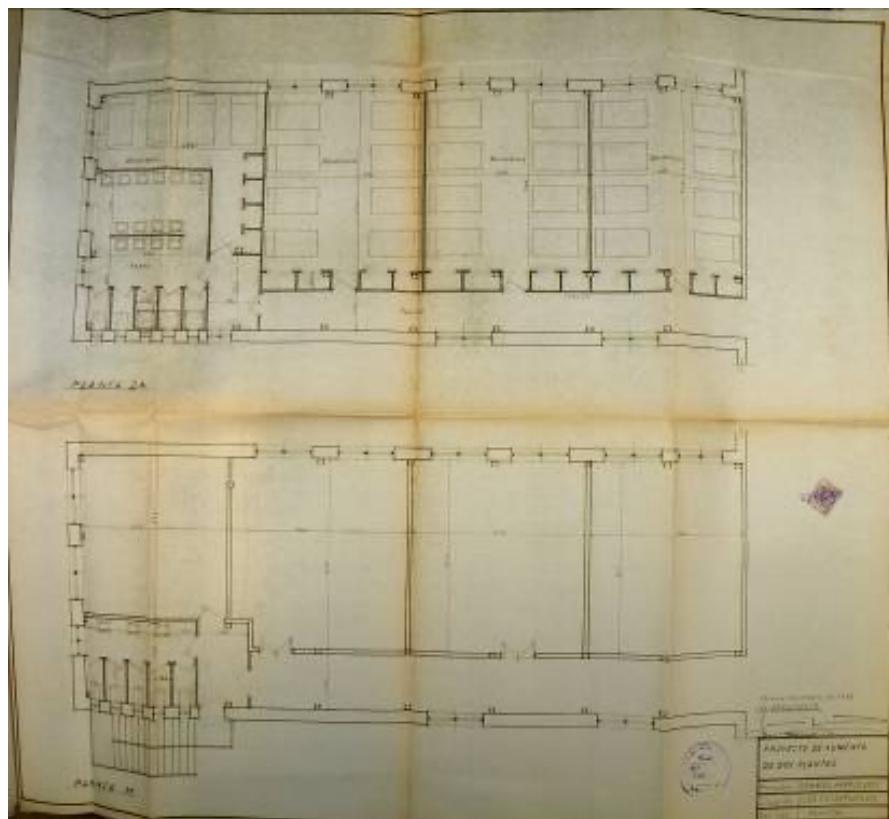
Plano. Aumento de dos plantas. AHPZa. DPV. 105/10.
